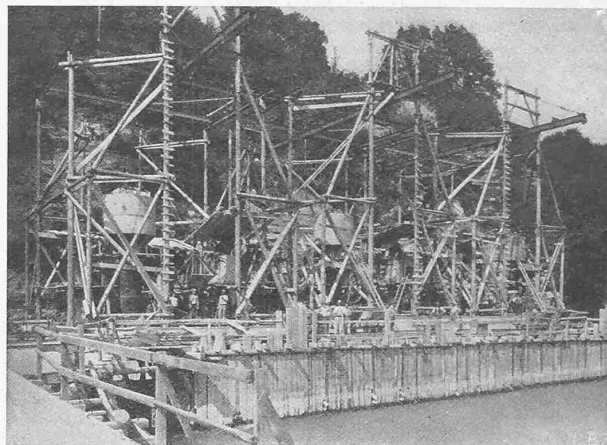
Caisson pour la pile I (rive droite). 30 juillet 1919.
